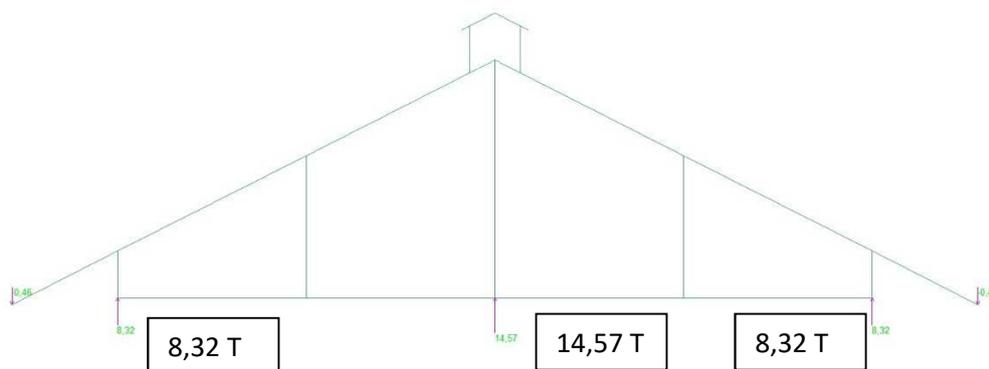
Усилия на колонну от конструкций покрытия
